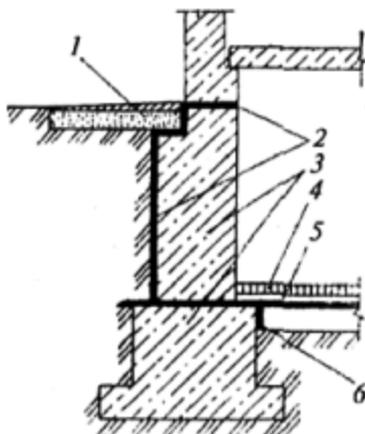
Гидроизоляция фундамента от капиллярного подсоса:
